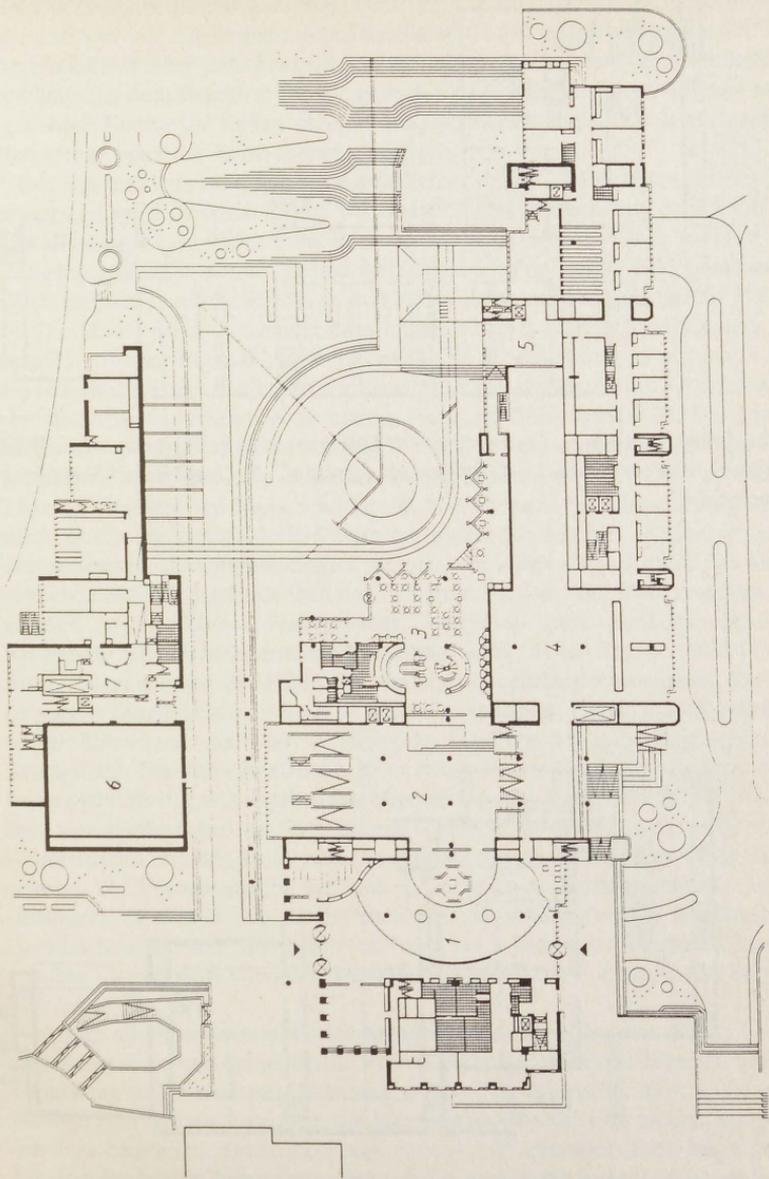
Köln, Museumsneubau, Grundriß Erdgeschoß. 1 Eingangshalle, 2 Treppenhaus, 3 Cafeteria, 4 Ausstellungssaal, 5 Agfa Foto-Historama, 6 Luftraum Untergeschoß (Museum Ludwig), 7 Restauration
